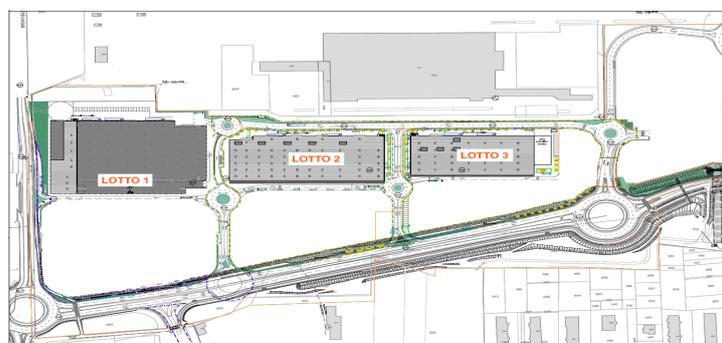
\_Estratto planimetrico del Piano Esecutivo Convenzionato
